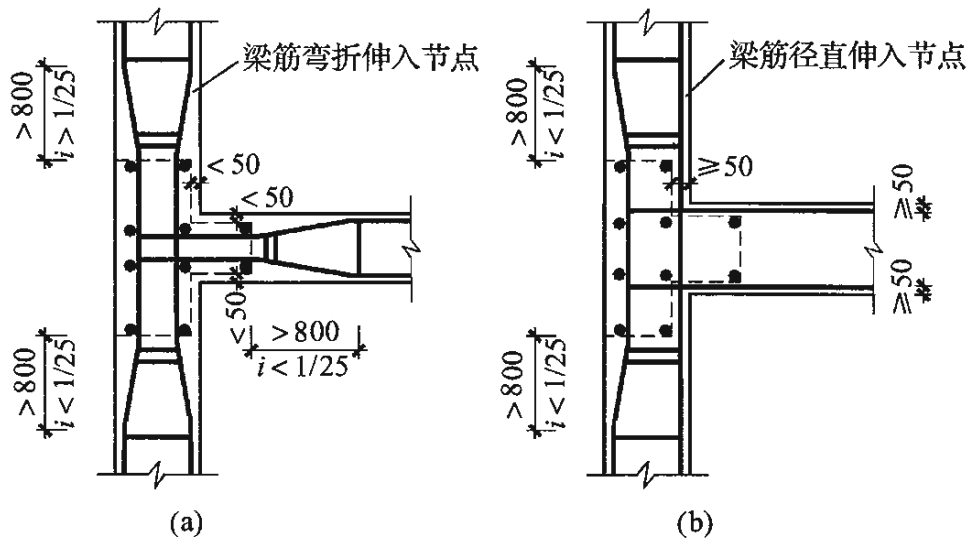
框架梁纵向钢筋伸入节点的构造要求
